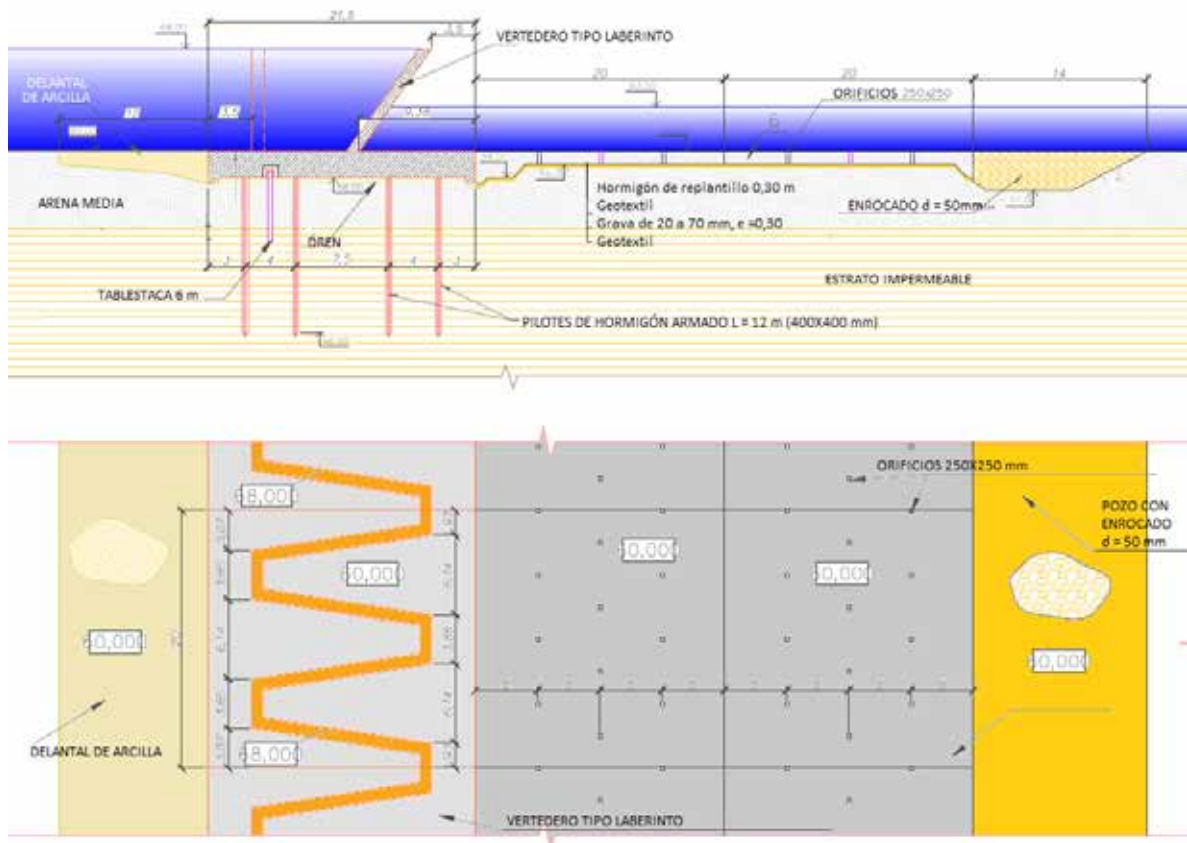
Vista en corte y planta de un diseño de una presa cimentada en suelo. Fuente: (Shuliak, 2016)
